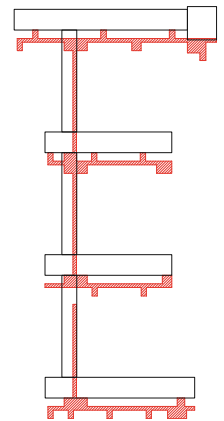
Grundriss Mannschaftstrakt Ost | Auslagerung Erschließung
